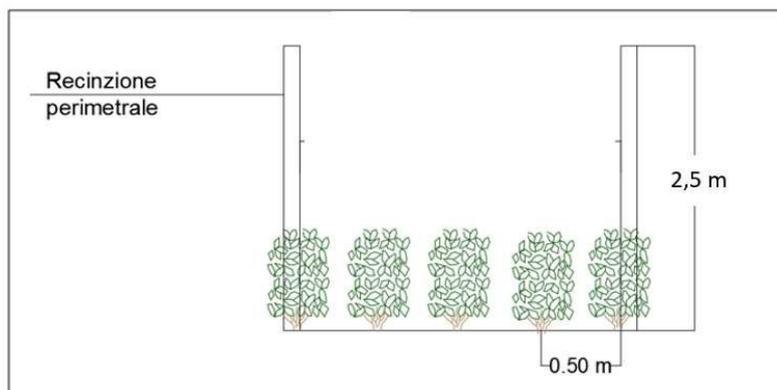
Disposizione piante arbustive lungo la siepe perimetrale
